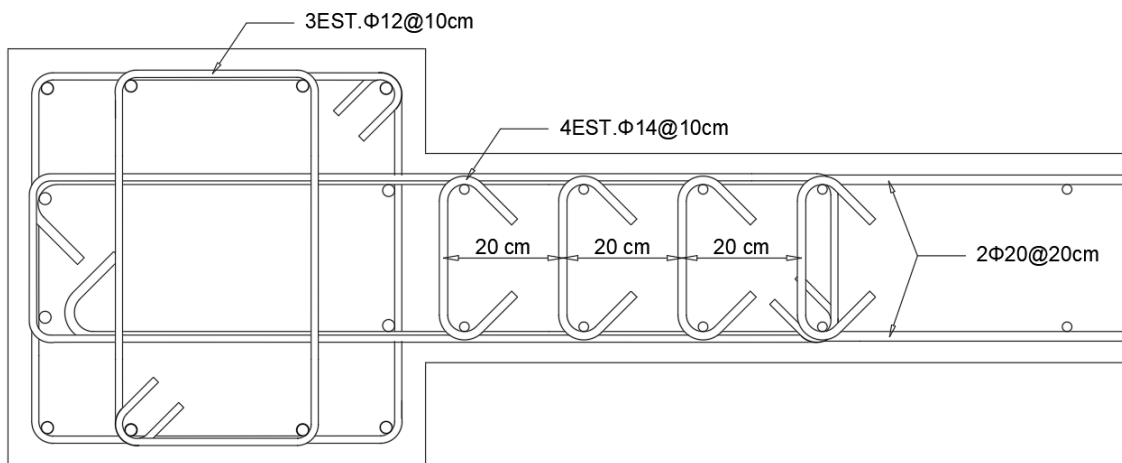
Estribos de confinamiento en cabezal de muro.
